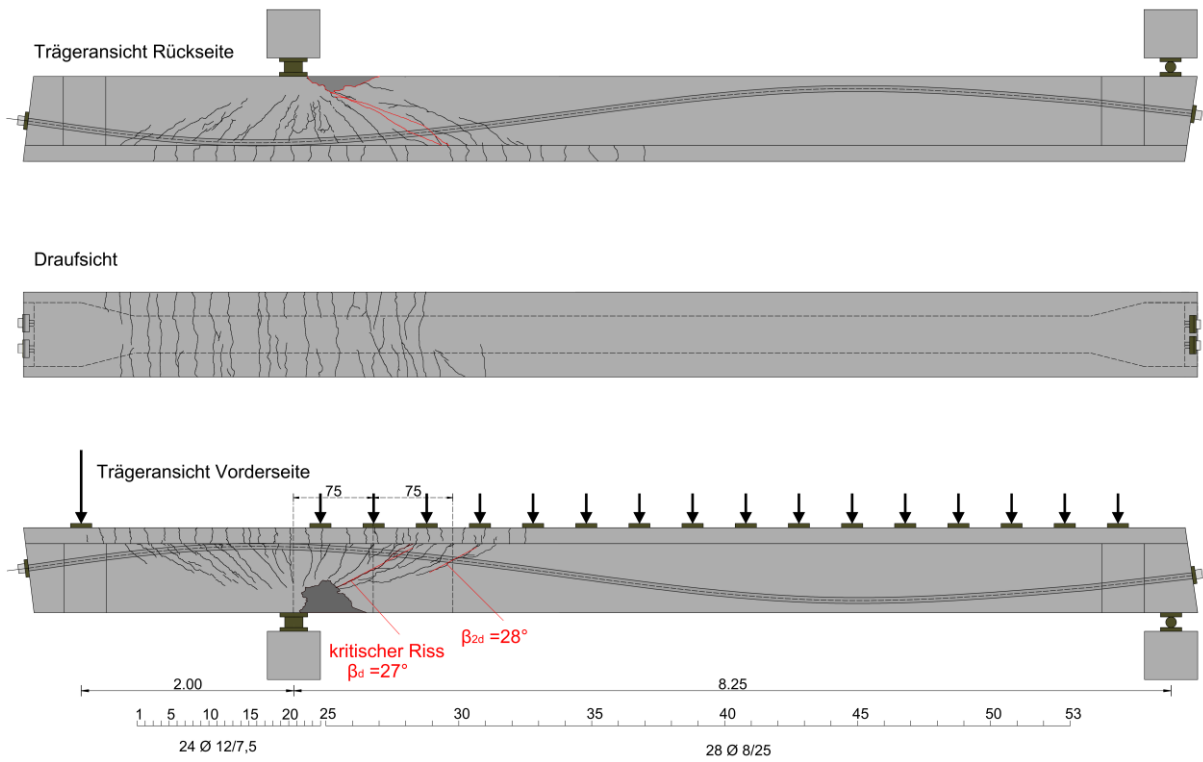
ETK1 Rissbilder unter Bruchlast
